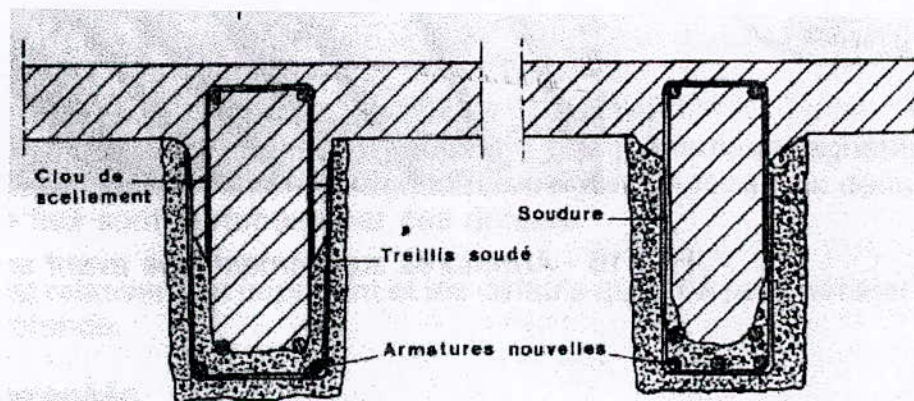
Armatures supplémentaires en surépaisseur de poutre
